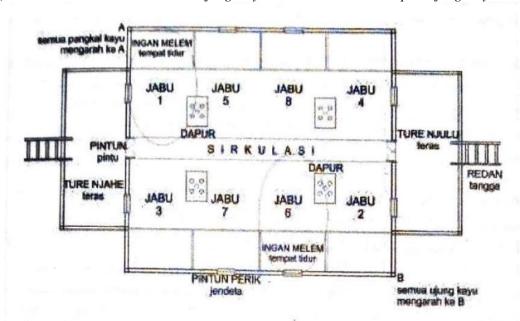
Floor Plan of the Karo Traditional House Source: Singarimbun, 1975.
